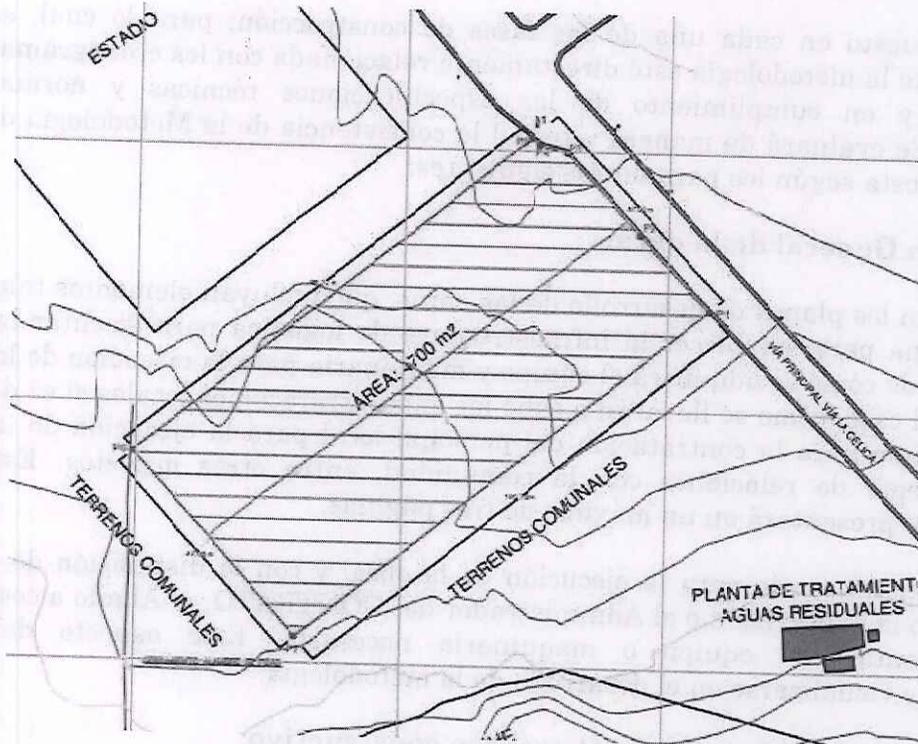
Levantamiento Topográfico Subestación Pedro Vicente Maldonado
